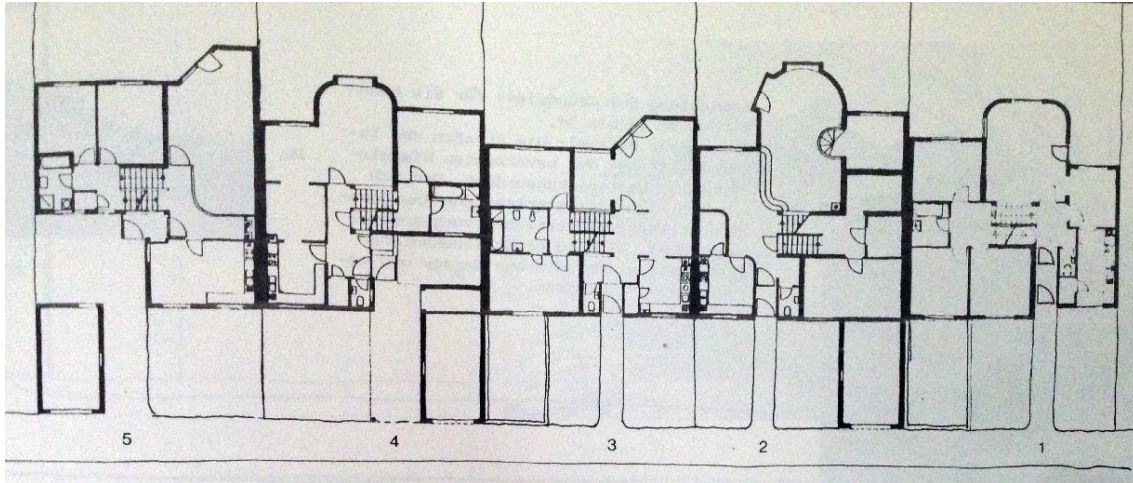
Grundrissabwicklung 1. Bauabschnitt Erdgeschoss Haus 1-5
